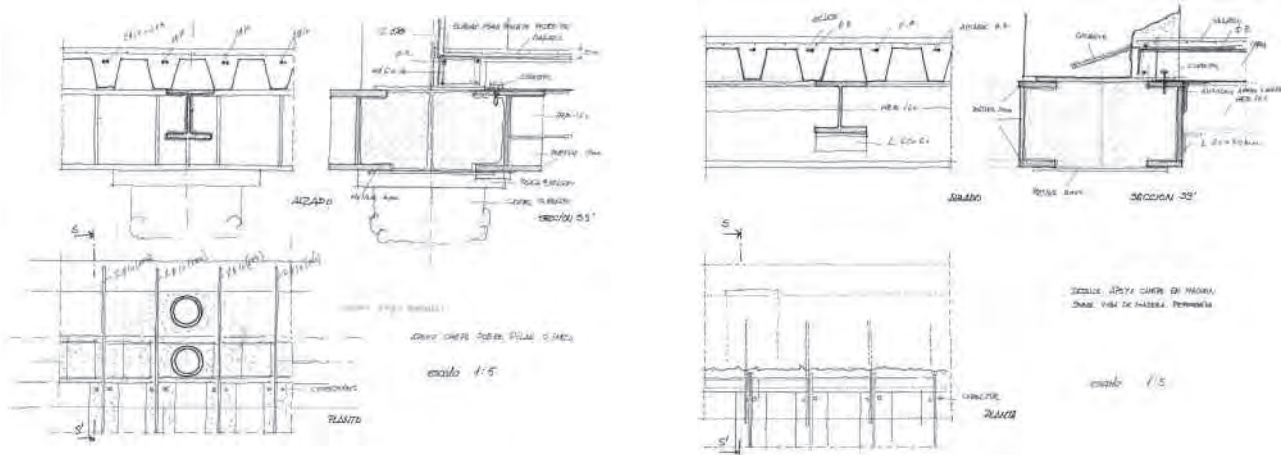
Detalles de refuerzos en pilares de fundación y vigas de madera.
